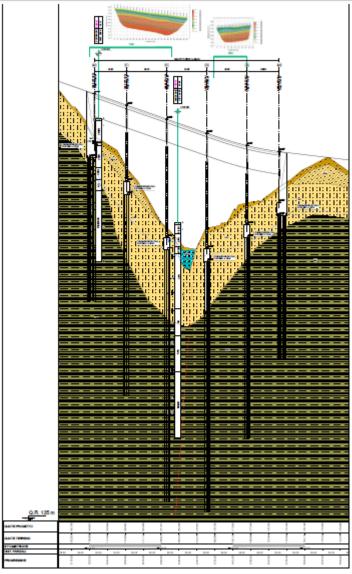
Stralcio del profilo geotecnico del ponte
